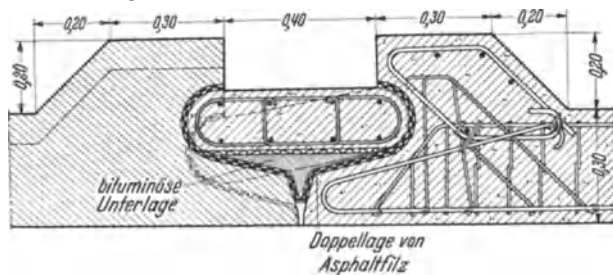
Bakhada-Staudamm. Fugenausbildung der vorläufigen Eisenbetondichtungsdecke.
